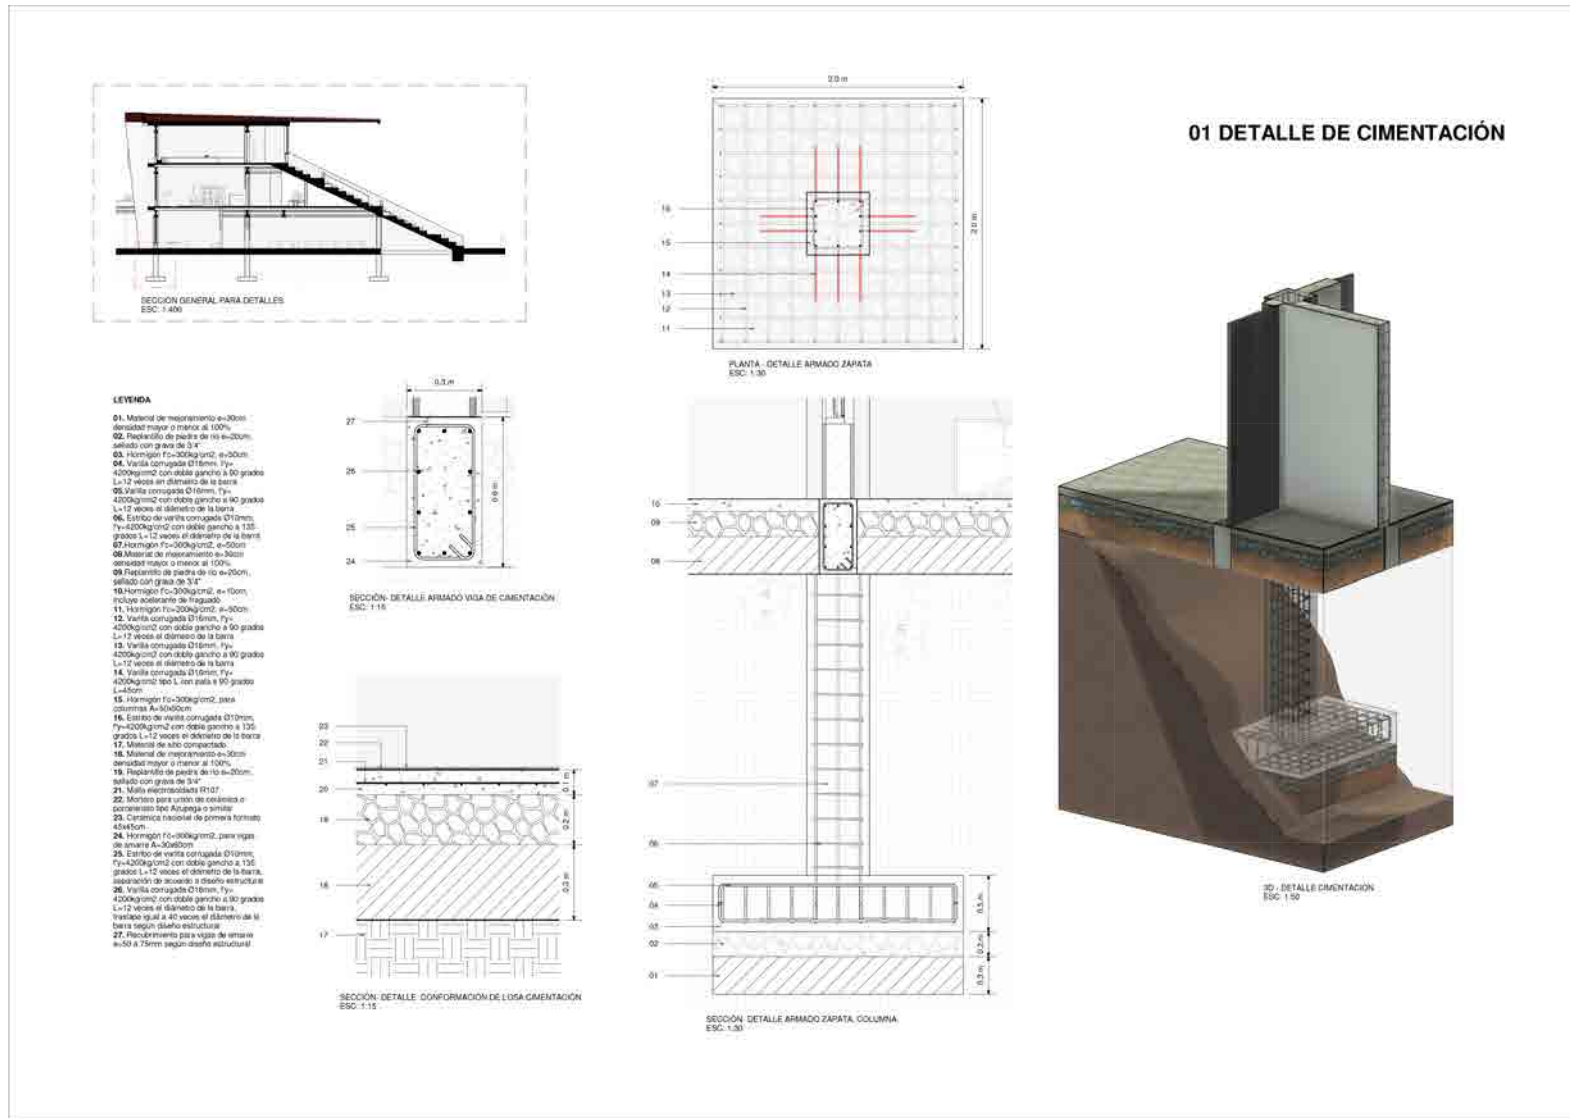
Detalle de cimentación. Elaboración: Autores.
